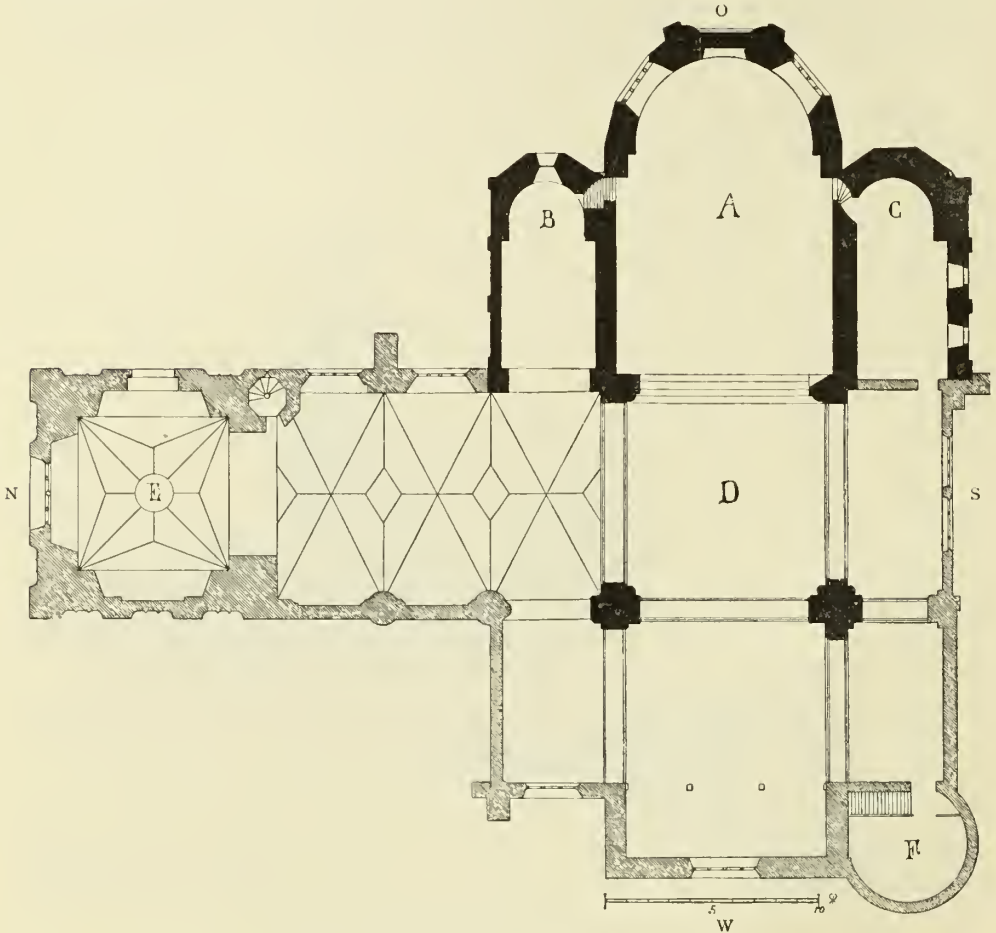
Emmerich. Grundriss der Münsterkirche.
